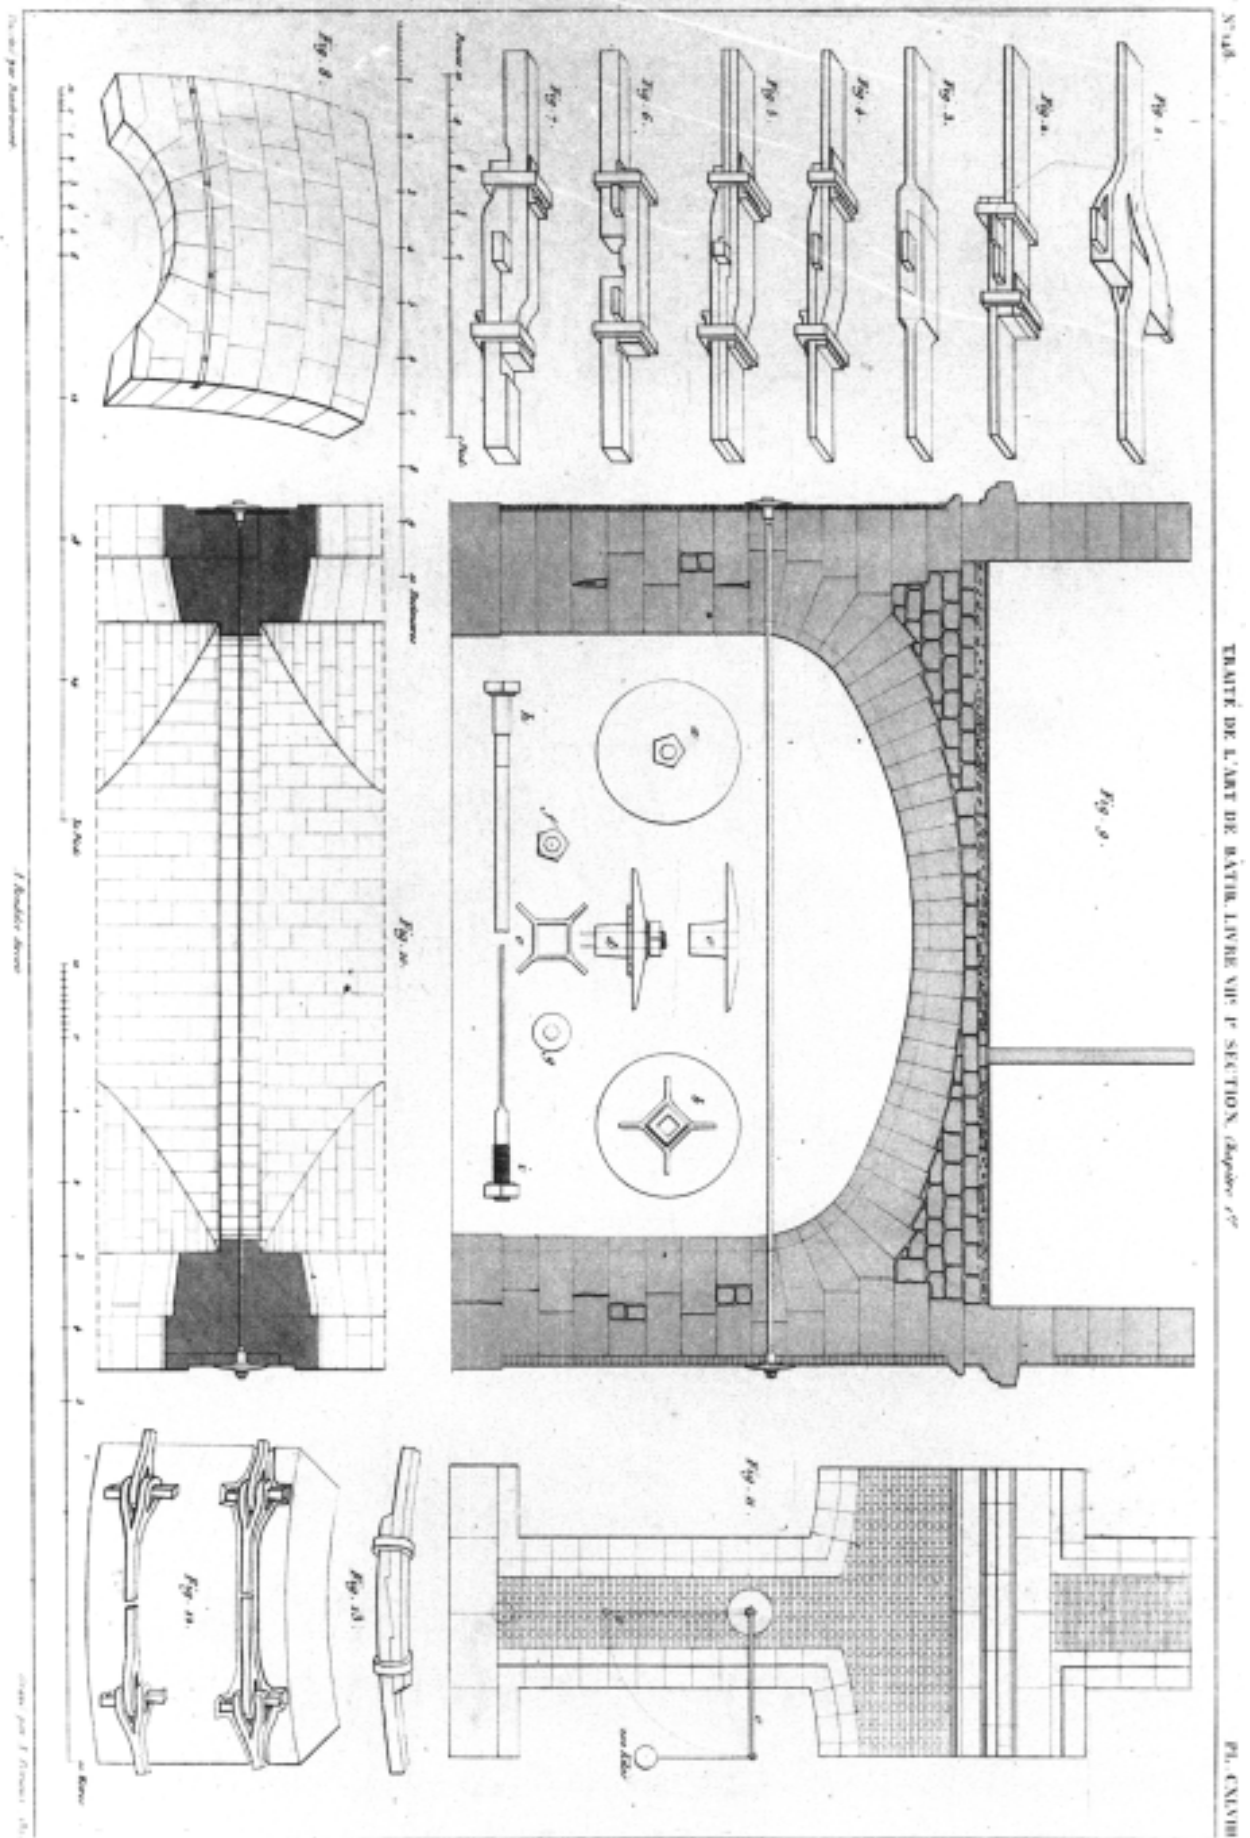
Rondelet 1812. Plan CXLVIII. Eisenanker zur Kompensation entstehenden Gewölbedrucks.
